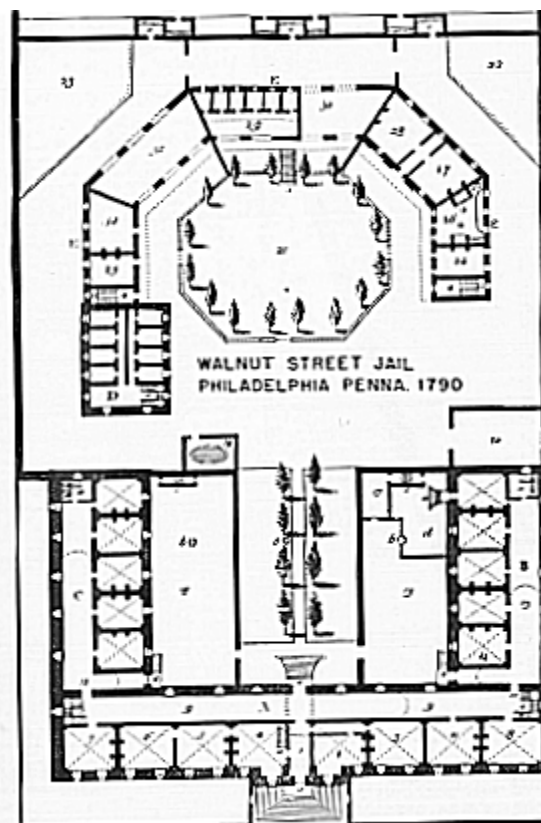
Planta de la Walnut Street Jail, Filadèlfia, 1790 (Gazis-Sax, 1998).
